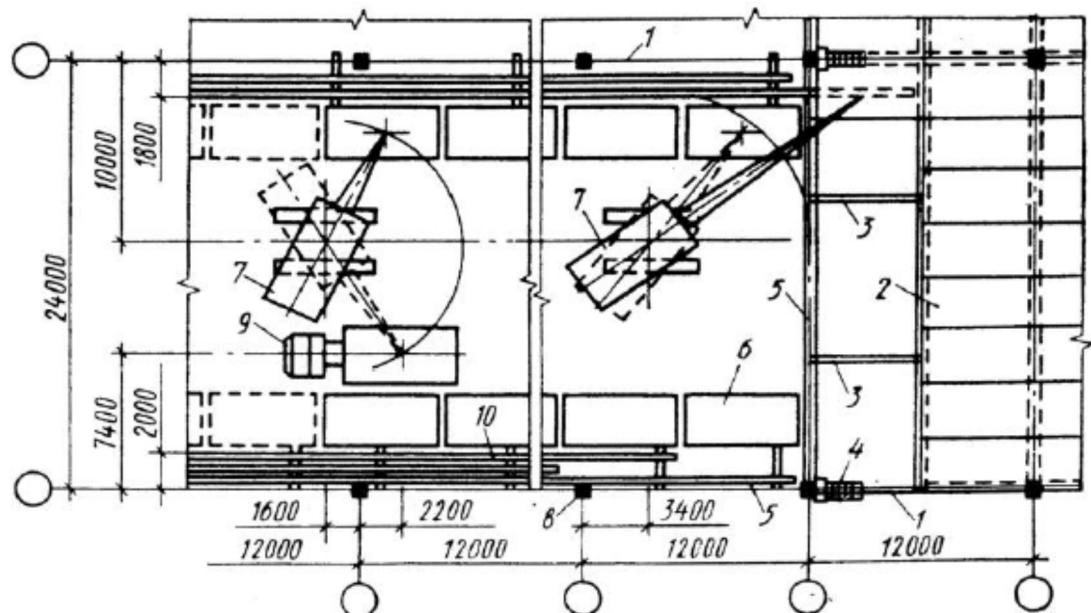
Схема выгрузки, раскладки элементов и монтажа покрытия в пролетах 24 м, с шагом колонн 12 м, ферм 6 м продольным методом: 1 - временное ограждение; 2 - смонтированное покрытие; 3 - инвентарная распорка для временного крепления ферм; 4 - лестница-площадка приставная; 5 - стропильная ферма; 6 - штабель плит; 7 - кран; 8 - колонна; 9 - транспортное средство; 10 - подстропильная ферма.
